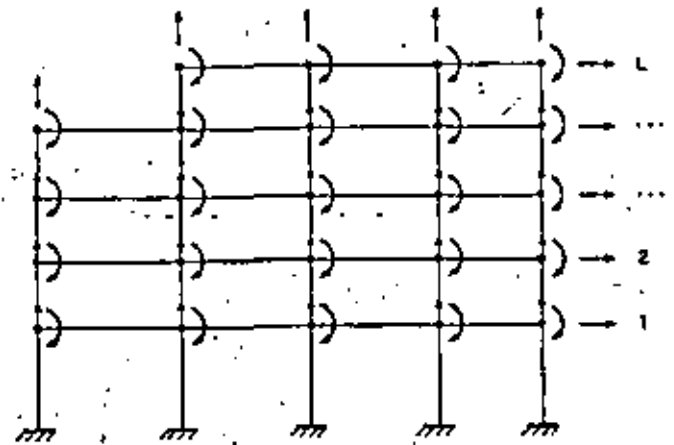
Grados de libertad del sistema plano de la fig 2.12
